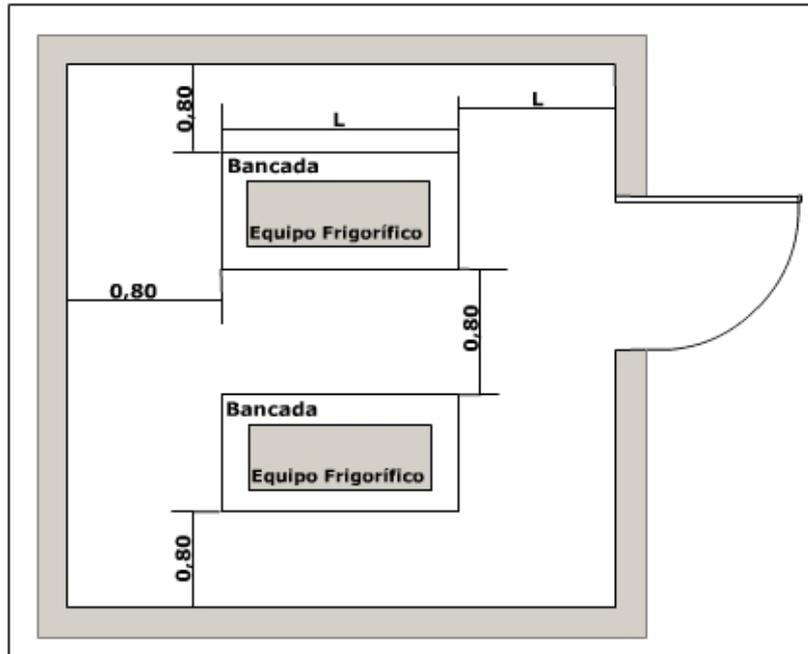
Planta de la sala de máquinas frigoríficas (cotas en metros)
